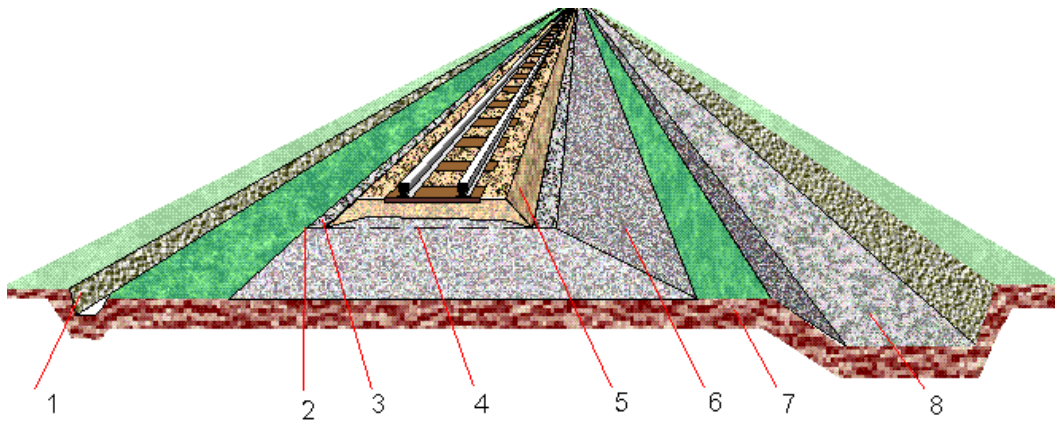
Типовой поперечный профиль насыпи, 1-водоотводная канава; 2-бровка; 3-обочина; 5-балластный слой; 6-откос; 7-берма; 8-резерв
